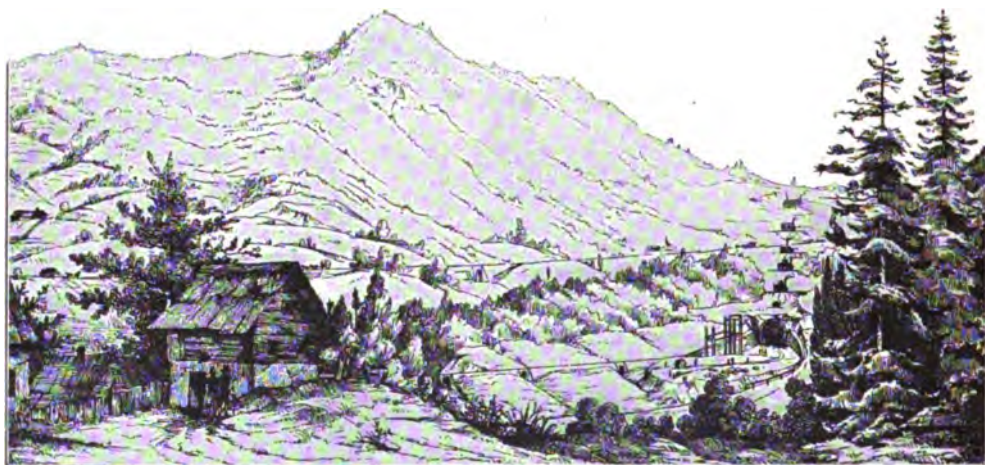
Der Bau des Haupttunnels durch den Semmering.
